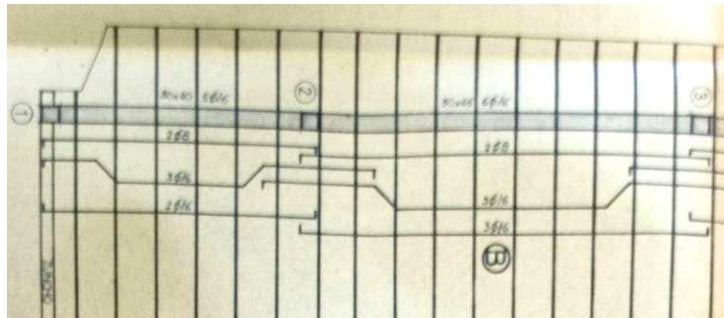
Planos de estructura. Edificio ficha 236C.009, 1972.
